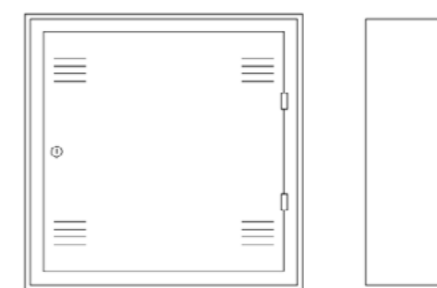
Caixa de distribuição interna - modelo tipo metálica 1
